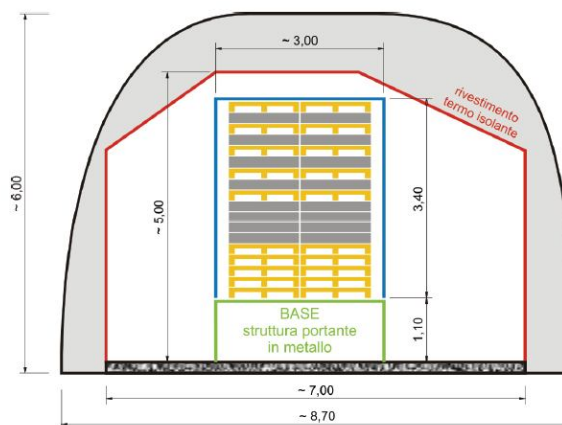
Rappresentazione schematica di uno dei test svolti all'interno del Runehamar Tunnel: sezione trasversale test T2
